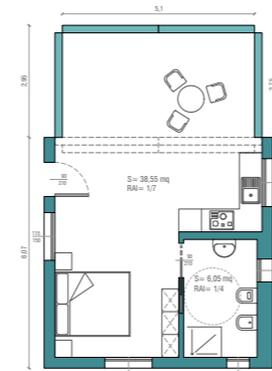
Pianta modulo singolo con pareti aperte - variante 2. Scala 1:200
